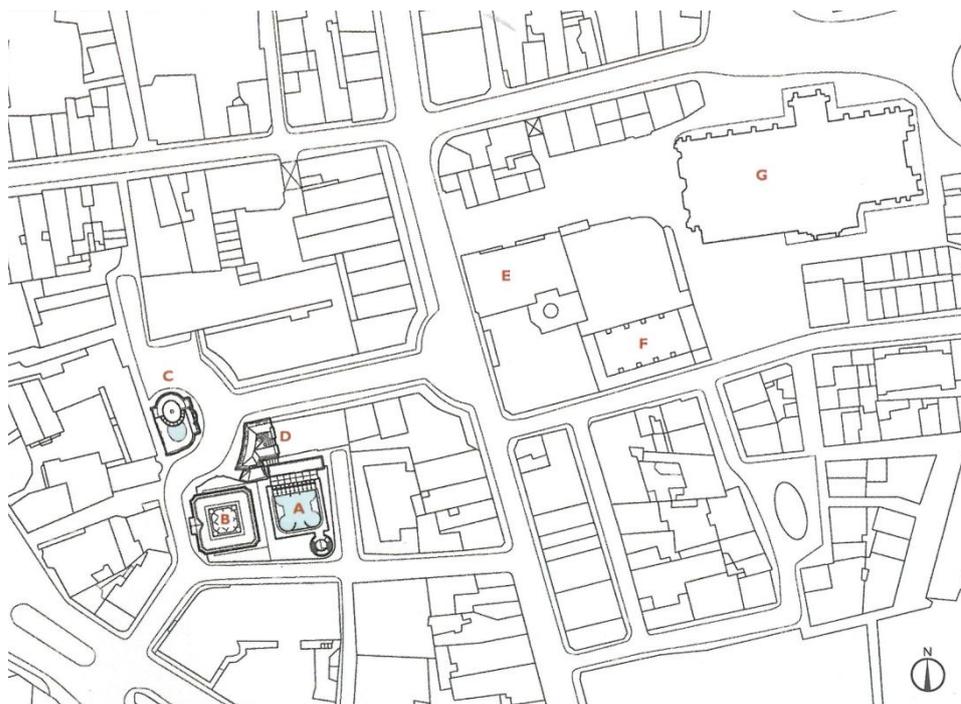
Planimetria generale. Edifici: A) Royal Bath, B) Hot Bath, C) Cross Bath, D) 7/7A/8 Bath Street, E) Pump Room, F) Roman Baths, G) The Abbey
